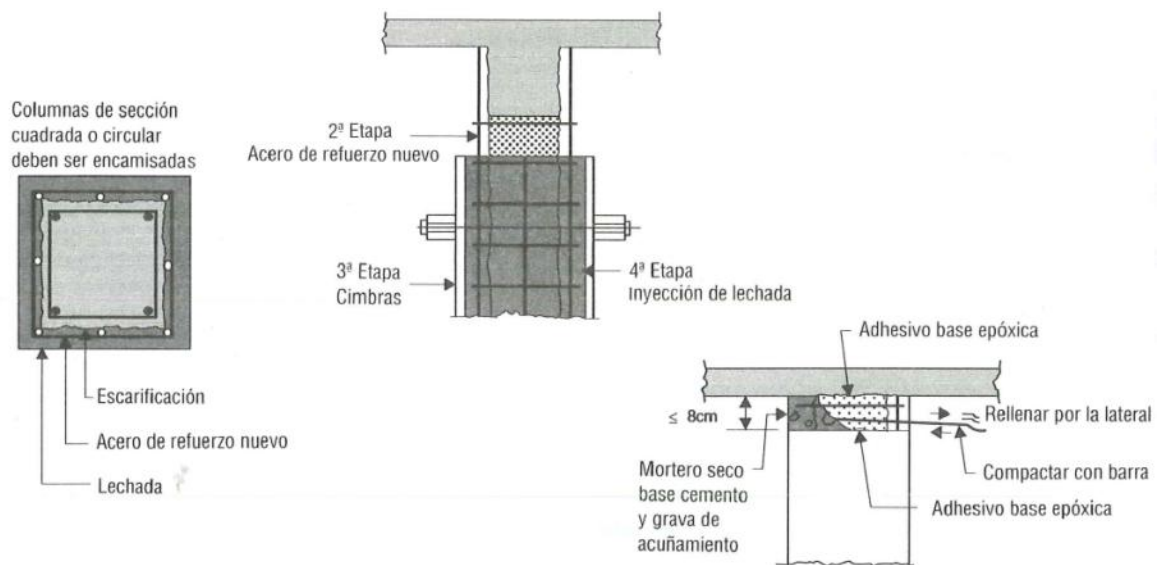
Propuesta de intervención para las columnas de los pórticos (refuerzo y aumento de sección)
